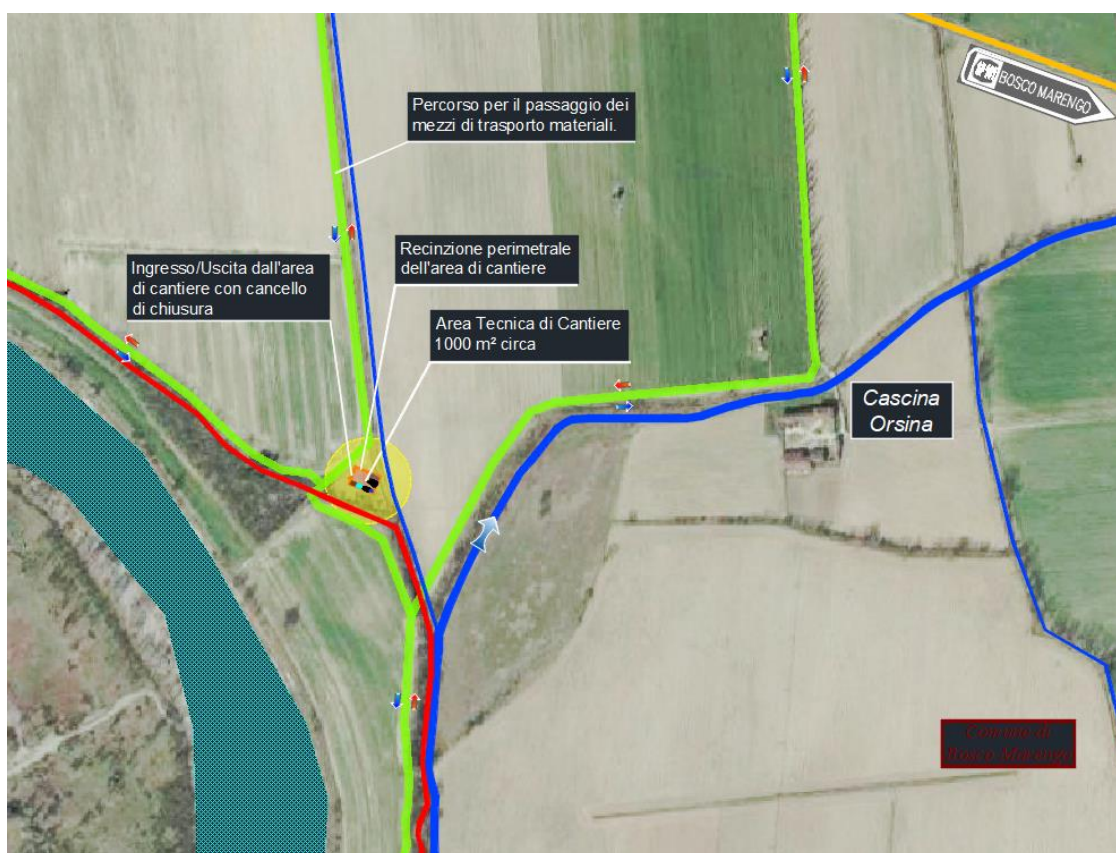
PLANIMETRIA DI CANTIERE
